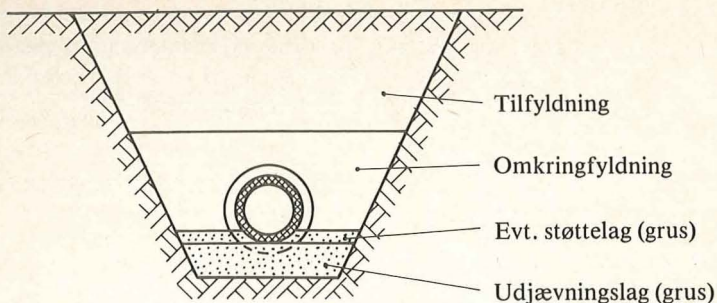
Understøtning af tunge rør (beton- og lerrør). Ved ledningsfald større end 700⁰/₁₀₀ bør udjævningslaget og et eventuelt støttelag cement- eller kalkstabiliseres. Ved ledningsfald større end 1000⁰/₁₀₀ bør udjævningslaget udføres af beton.
